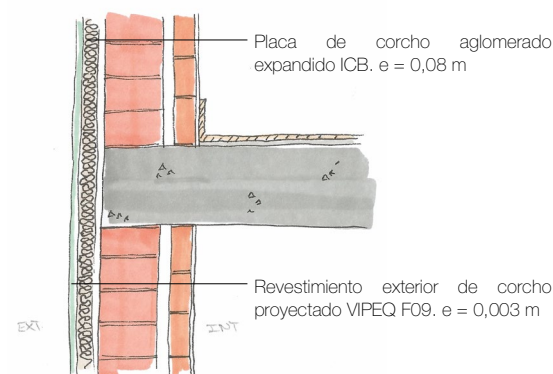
Encuentro forjado con pared de fachada con el sistema SATE implementado (autoría propia).
